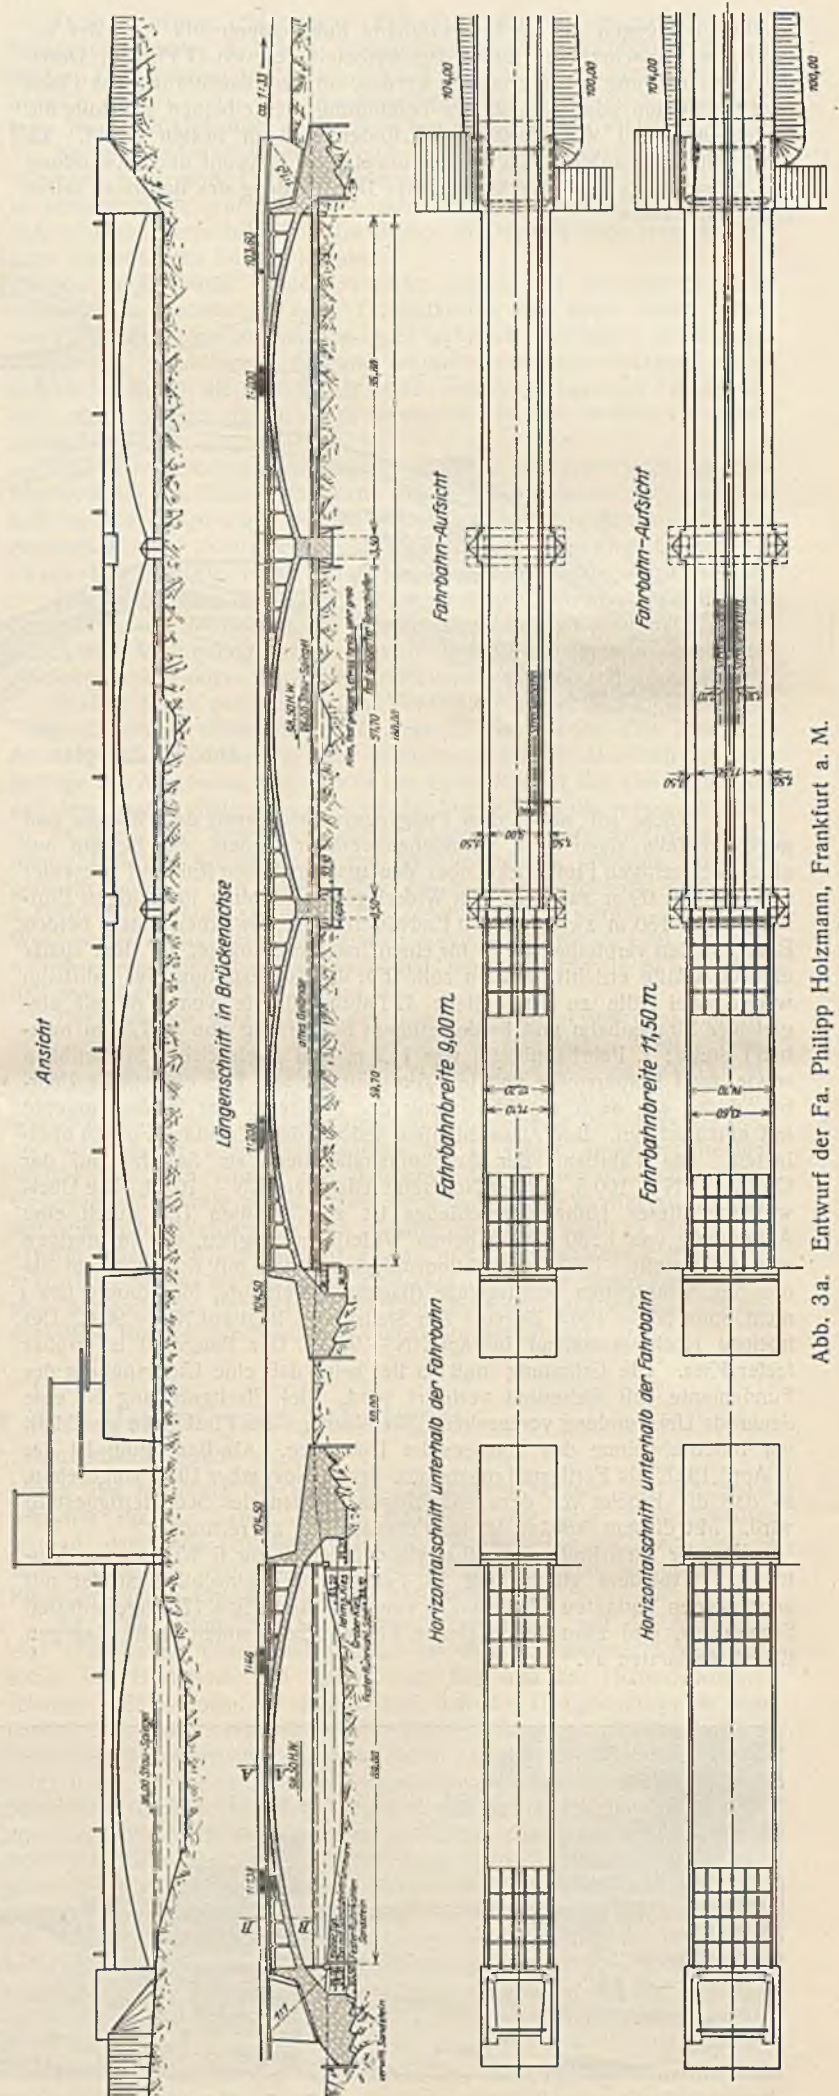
Entwurf der Fa. Philipp Holzmann, Frankfurt a. M.
